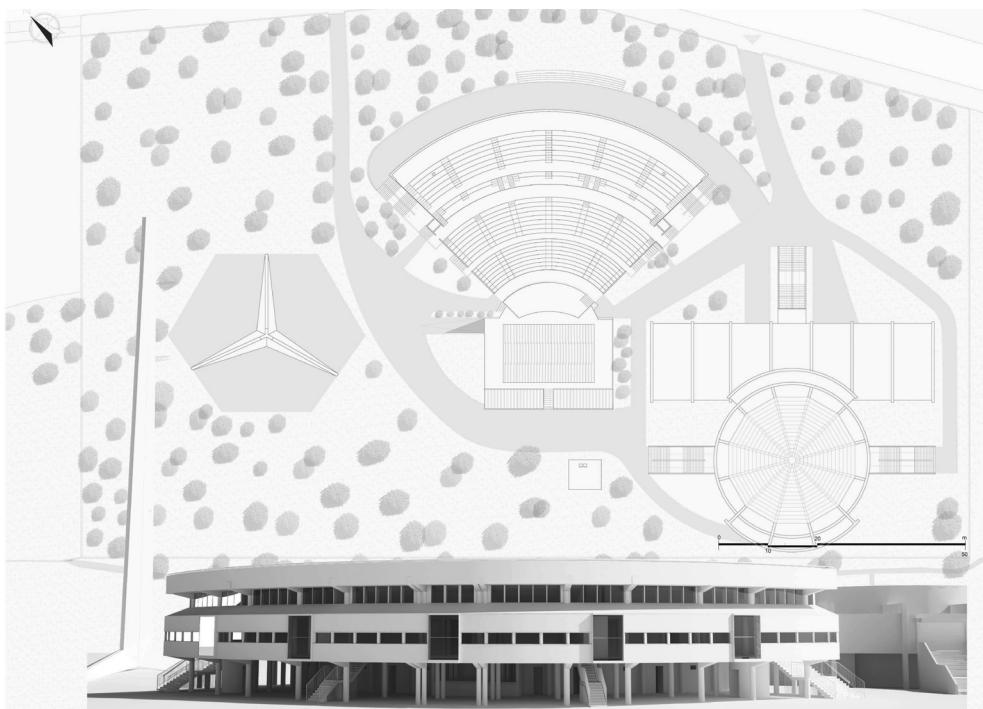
RILIEVO DELLA PIANTA PIANO TERRA E DEL PROSPETTO PRINCIPALE.
